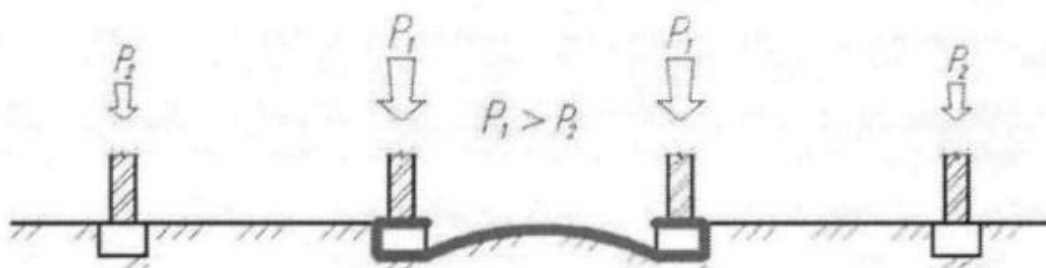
Фундамент будівлі з ділянками з різним навантаженням
